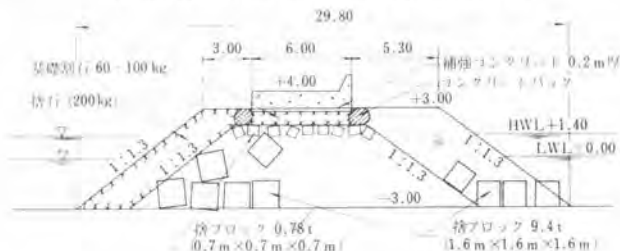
(B) ブロック堤標準断面図 (B区間 150 m)
